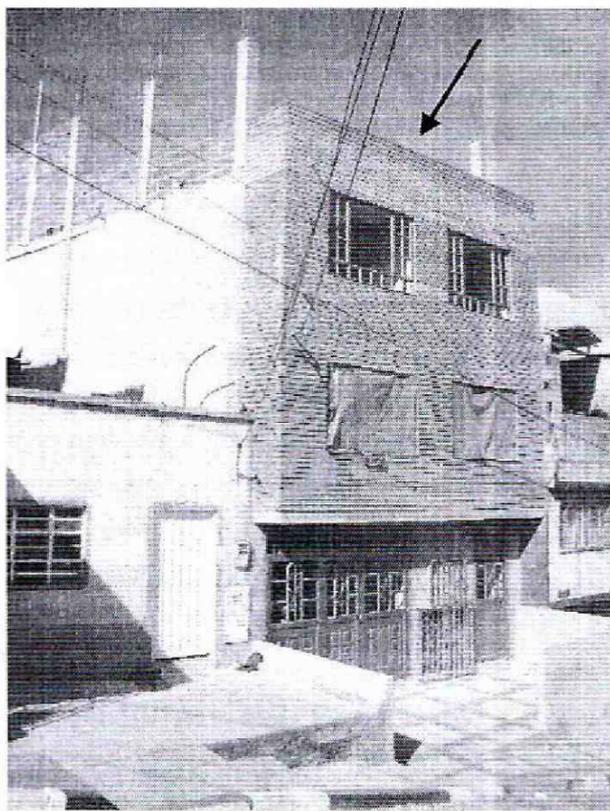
Predio en donde se desarrollará el proyecto ubicado la Diagonal 3B # 1B-31 Este, de la Localidad de Santa Fe.
